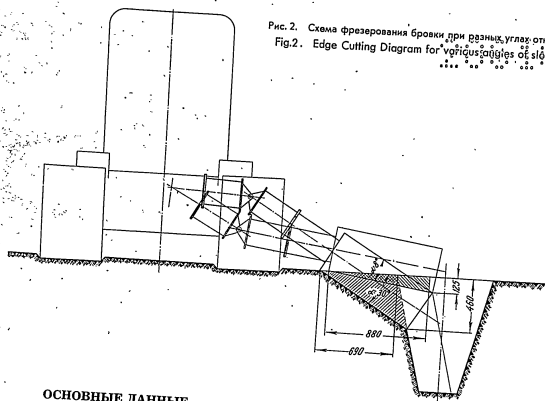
Схема фрезерования бровки при разных углах откоса
